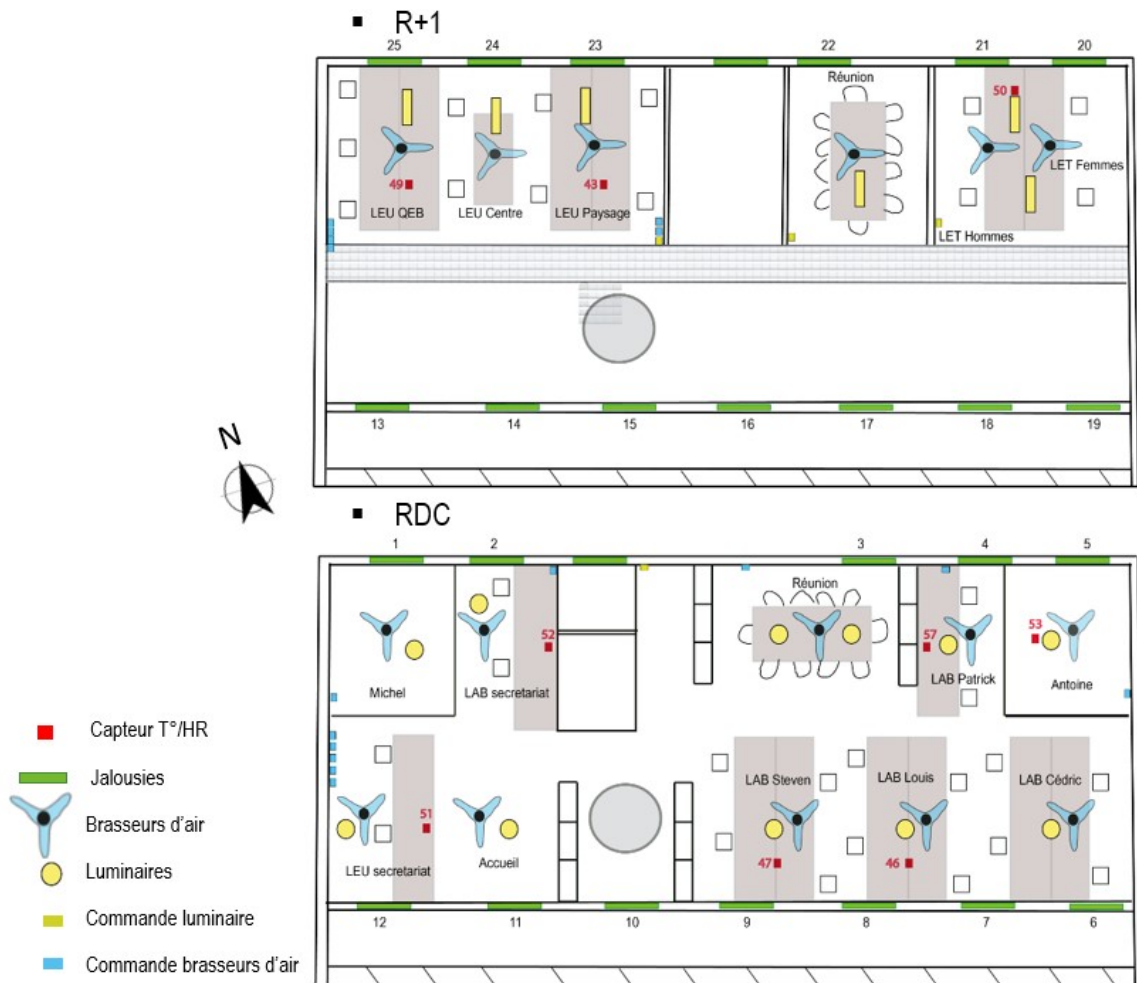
Plan d’implantation des commandes, Rez-De-Chaussée et étage des bureaux de l’Ilet du Centre
